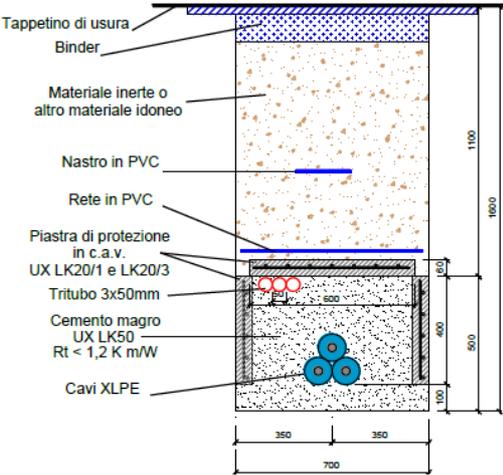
Sezione di scavo per cavidotto AT su sede stradale
